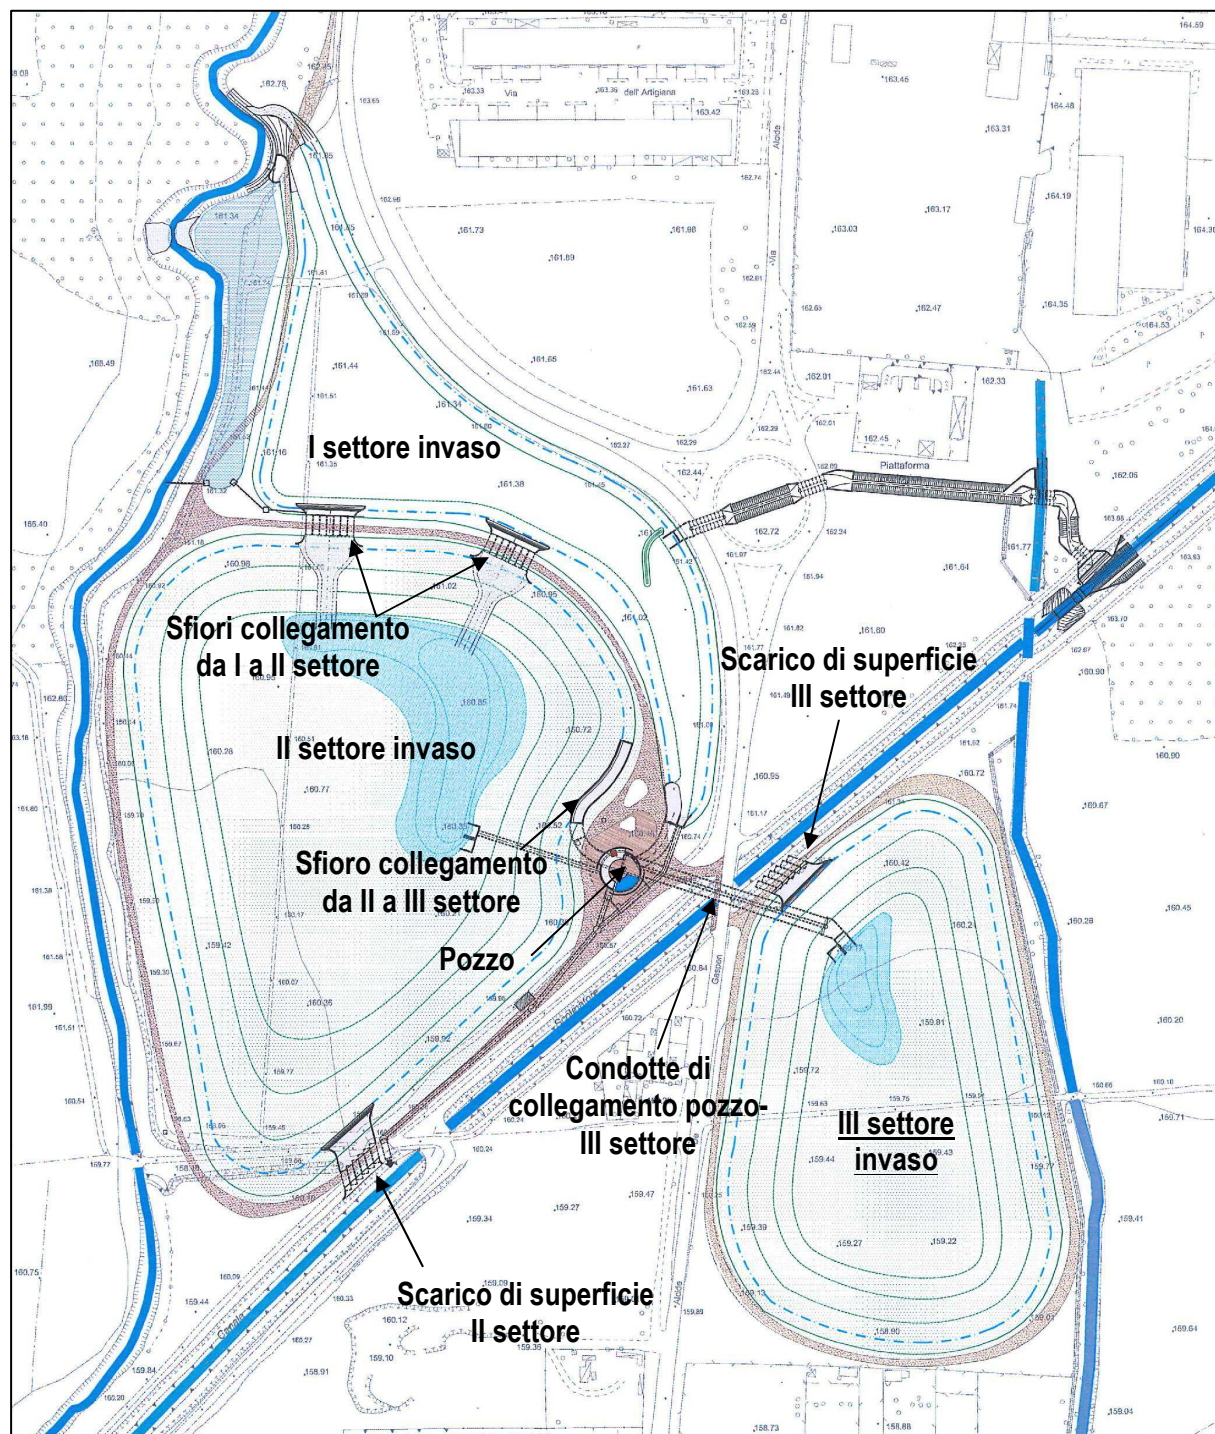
Planimetria della vasca di laminazione di Senago con indicazione delle opere idrauliche di collegamento tra i diversi settori di invaso
